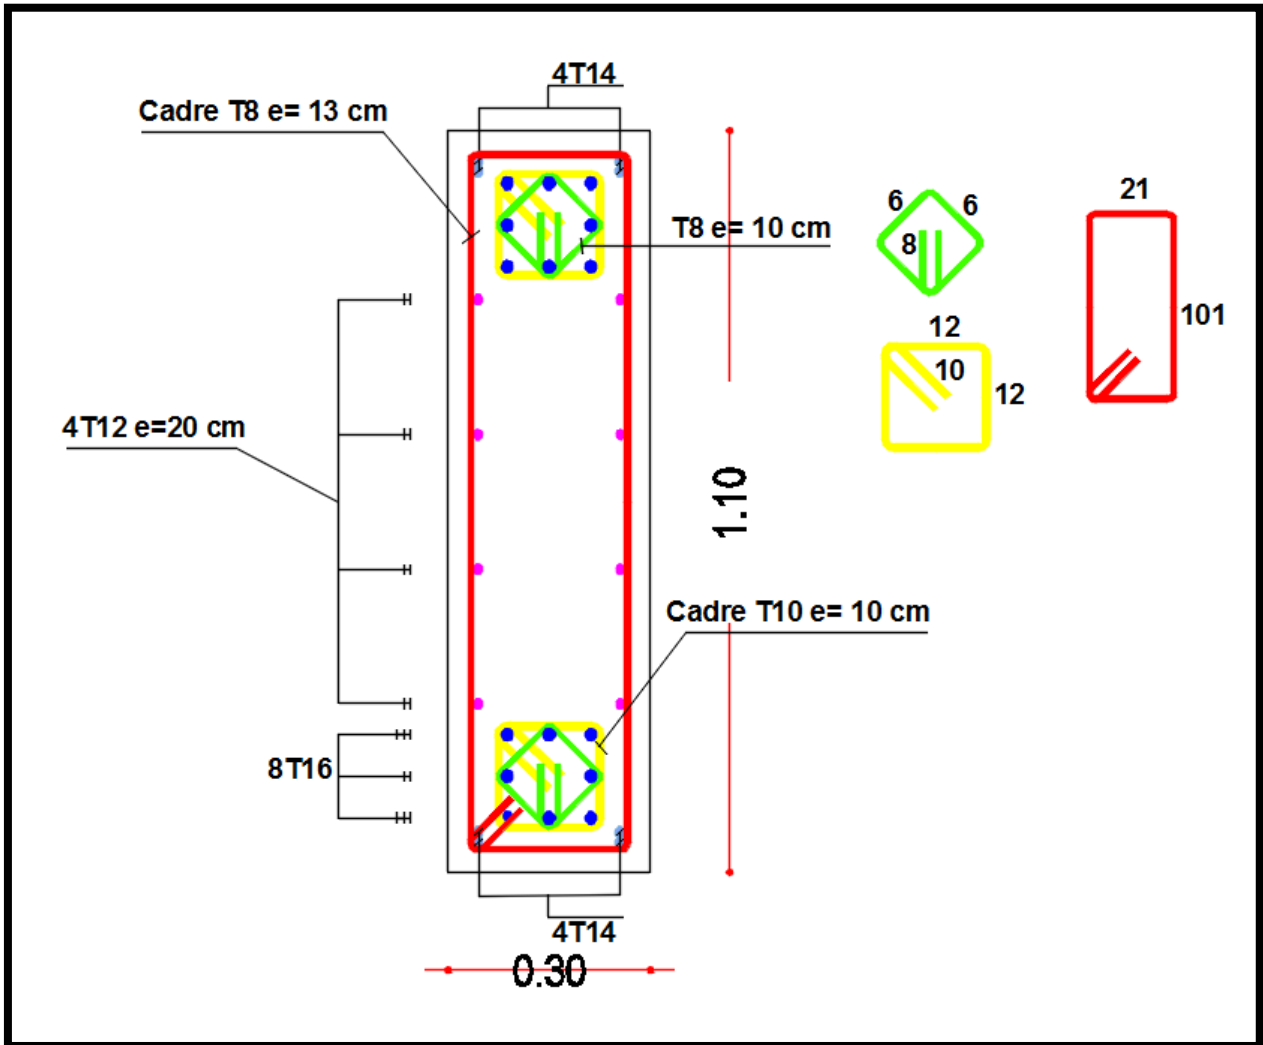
Coupe transversale de ferrailage du linteau étage courant
